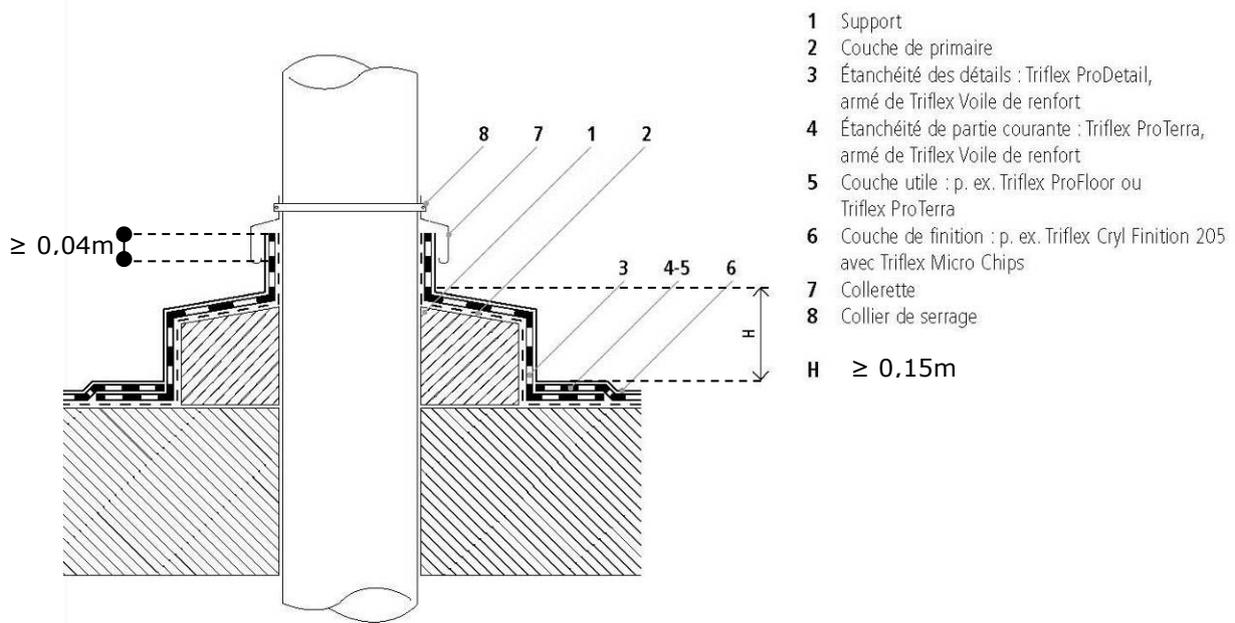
Traversée avec dé en béton des toitures-terrasses accessibles aux piétons - solutions Triflex BTS-T et BTS-P – Tuyau renforcé
